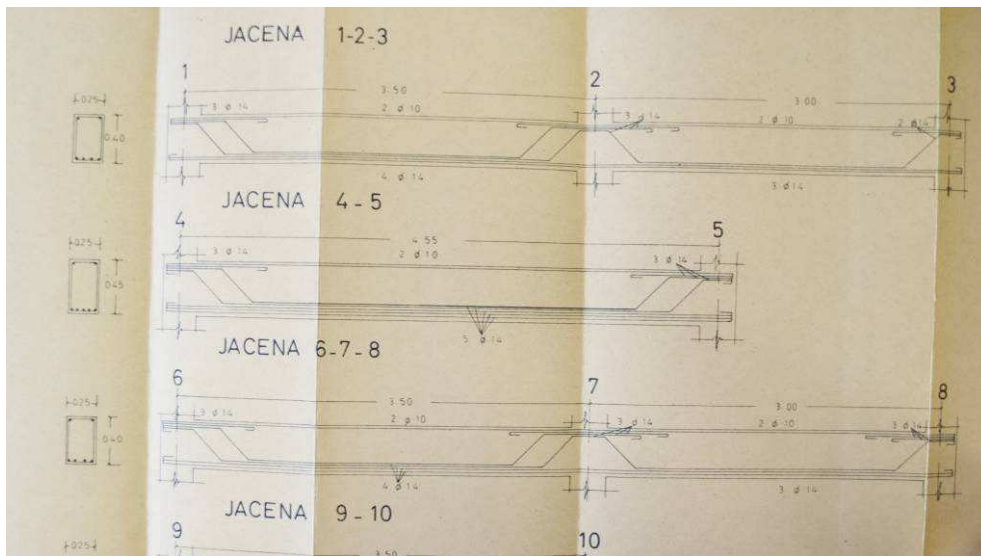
Plano de estructura de vigas. Edificio ficha 163C.009, 1962.
